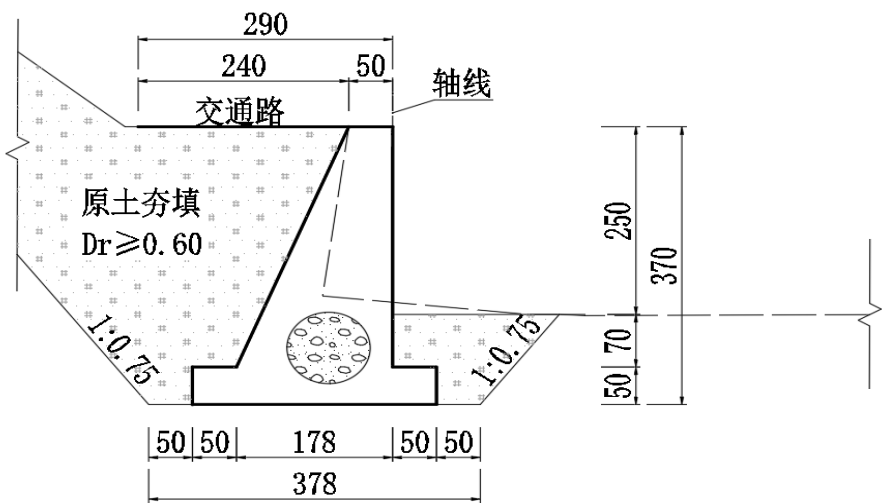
埋石混凝土挡墙护岸典型横断面图（比选）
